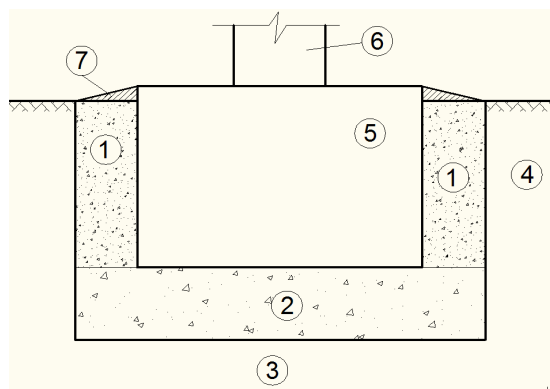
Фундамент с сейсмоизолирующим экраном:
